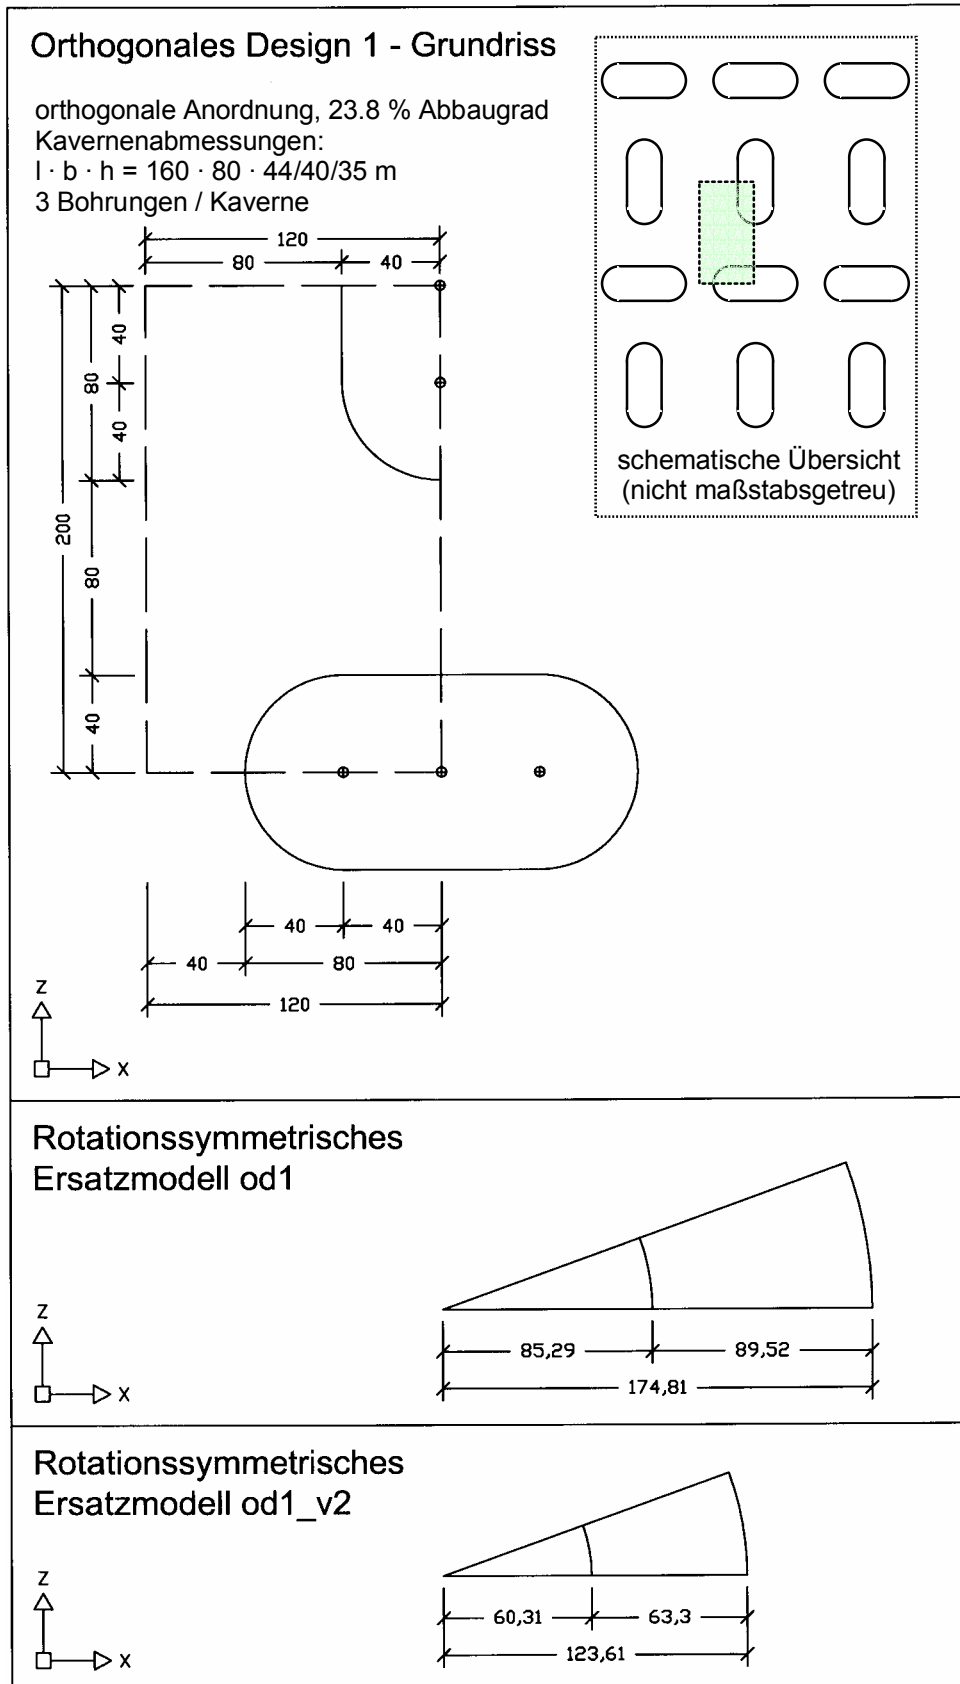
Orthogonales Design 1 – Grundriss und rotationssymmetrische Ersatzmodelle
